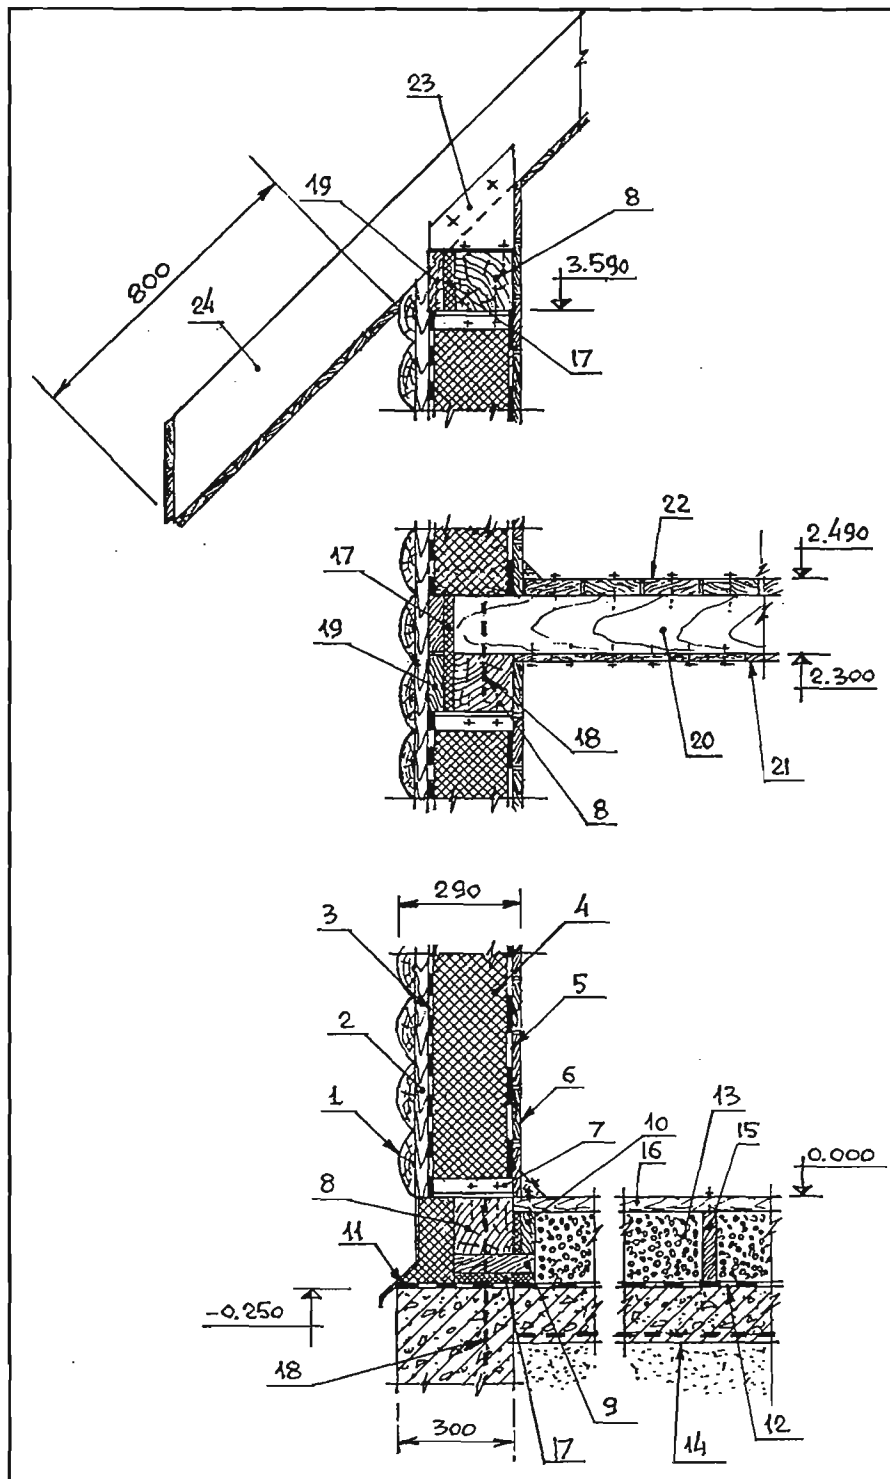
Конструкция наружной стены, пола и перекрытия здания: 1 — облицовочная доска типа «блок-хаус» 40 мм; 2 — брусок сечением 50х30 мм для создания воздушной полости; 3 — диффузионная пленка (типа «Ютафол Д140»); 4 — утеплитель «Нобасил М» слоем 200 мм; 5 — па-
